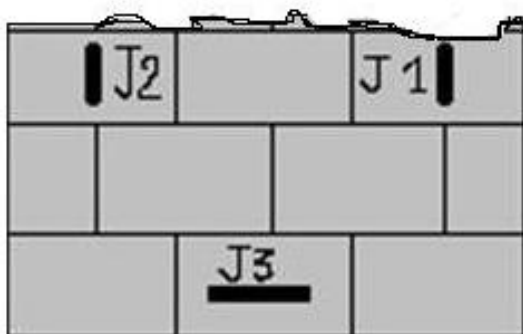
Schémas rupture mur de l'essai n°16.
